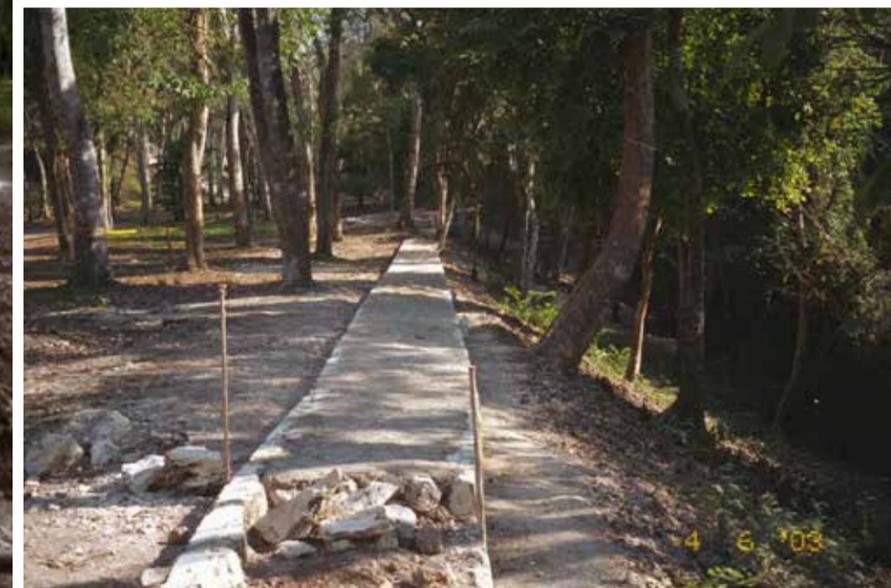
Calzada Blom, parapeto este acabados finales, resane de muros, sisas y núcleos constructivos, impermeabilización del parapeto. Foto: TLCM 2003
